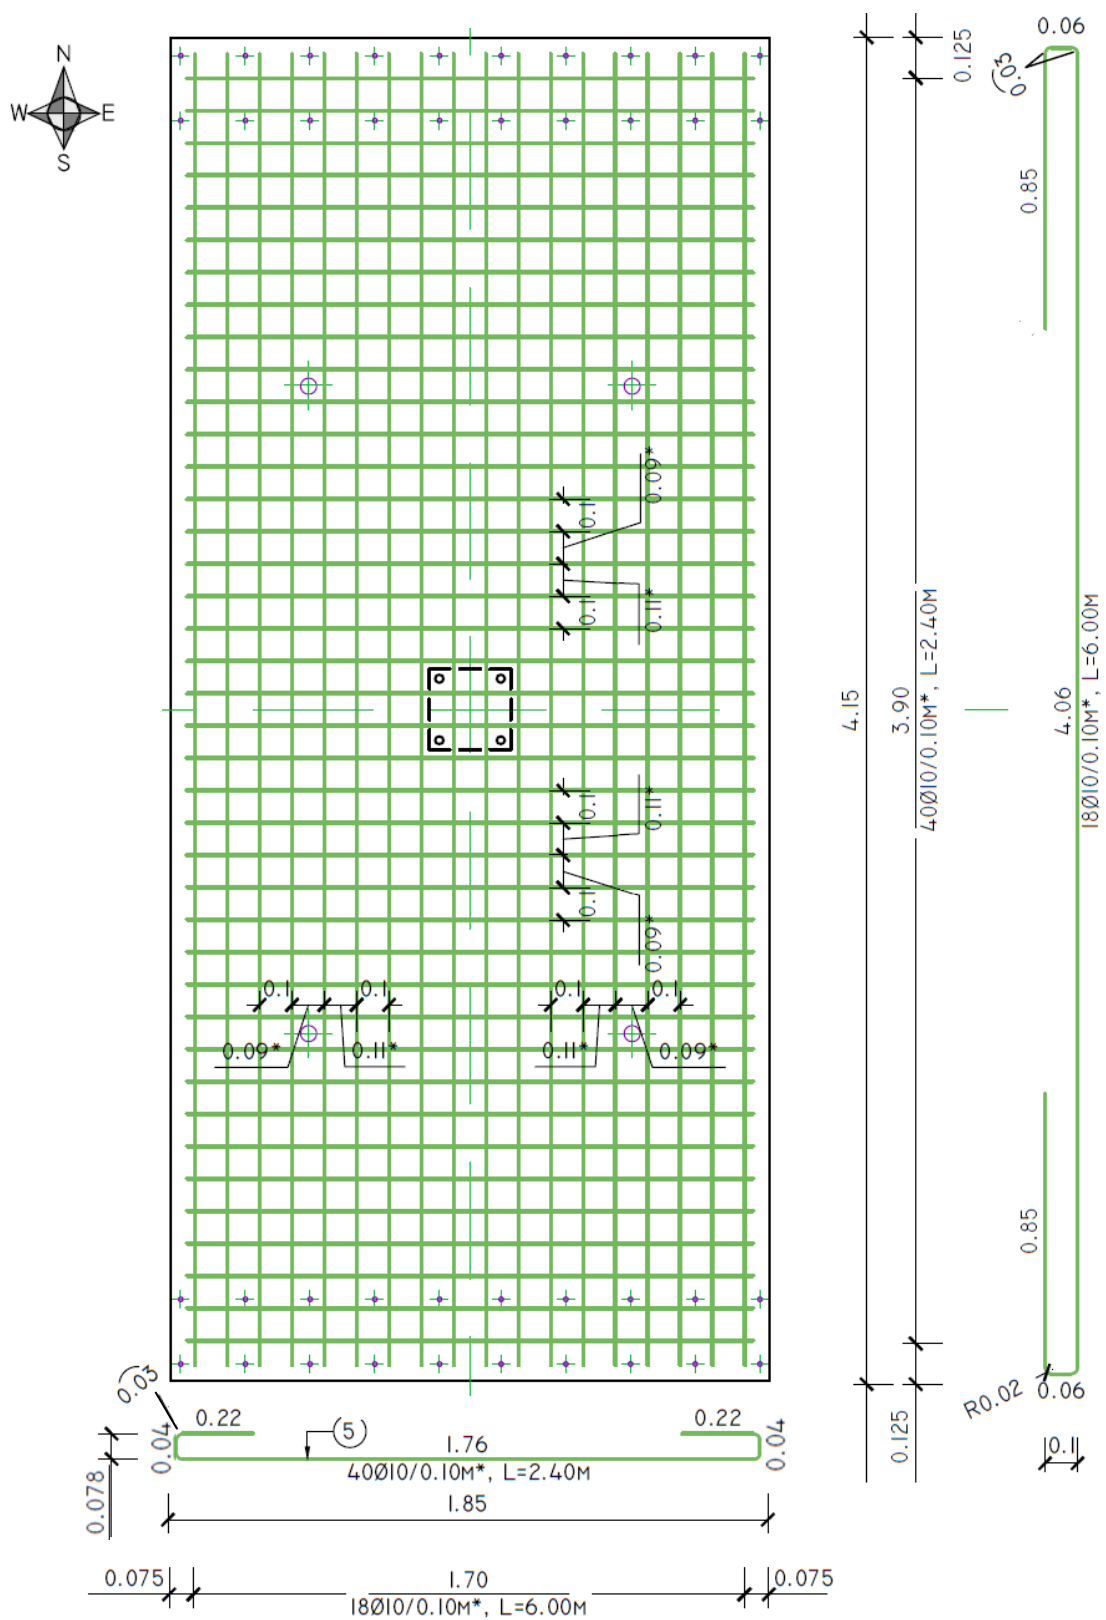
Pormenorização da armadura longitudinal inferior instalada em cada um dos três modelos de laje.
